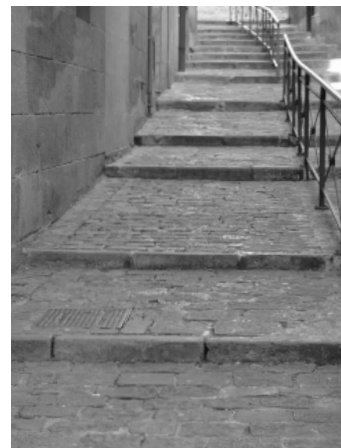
Vista de las barreras arquitectónicas de la calle Higuera que pretenden eliminarse con el ascensor propuesto. Fuente: Elaboración propia
